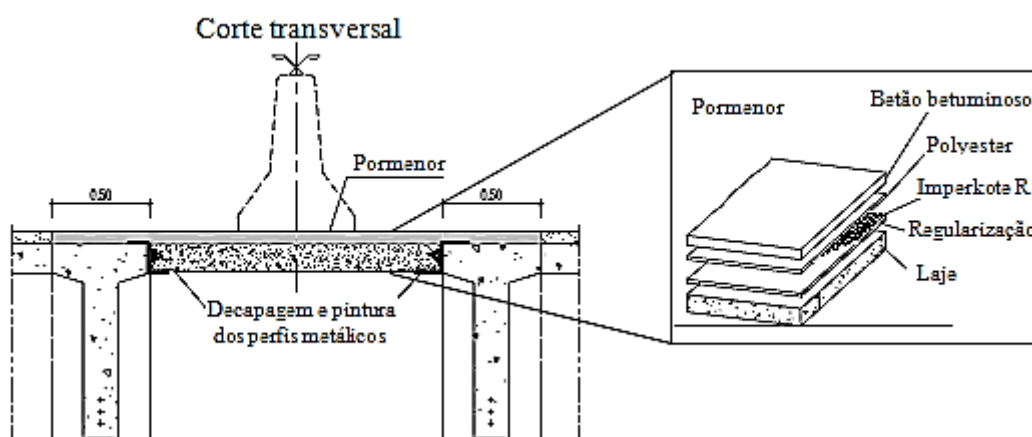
Pormenor da zona do Separador Central (adaptado de Brisa, 2002b).
